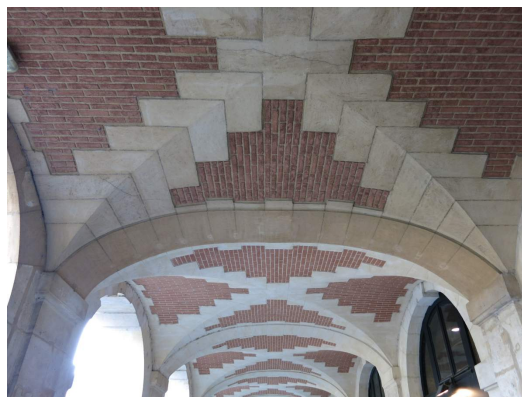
Place des Vosges, voûtes en plâtre sur ossature bois, à faux appareil; Pavillons à l'ouest de la place
